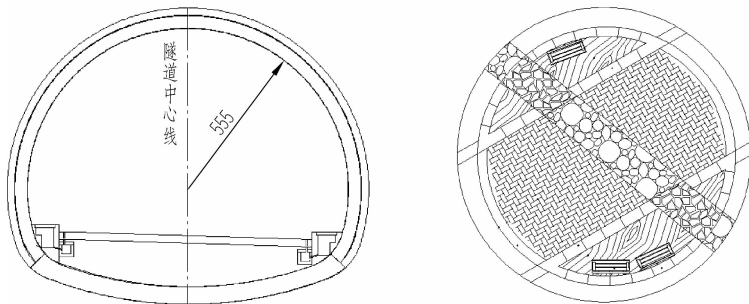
隧道施工图中圆弧及园林平面图中圆的使用
